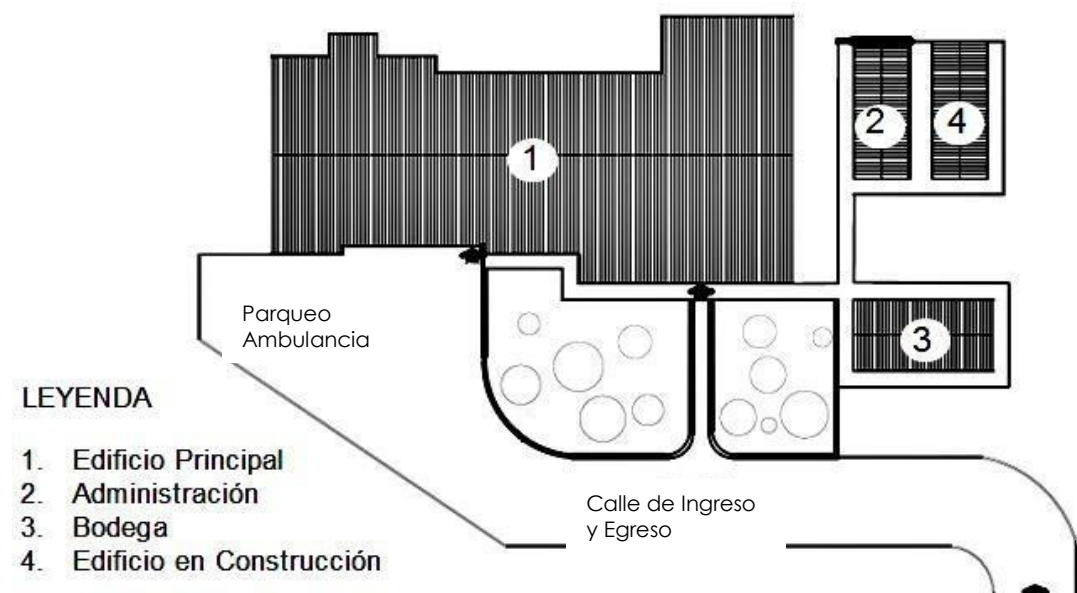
PLANTA DE CONJUNTO CENTRO DE SALUD GASPAR GARCIA LAVIANA
